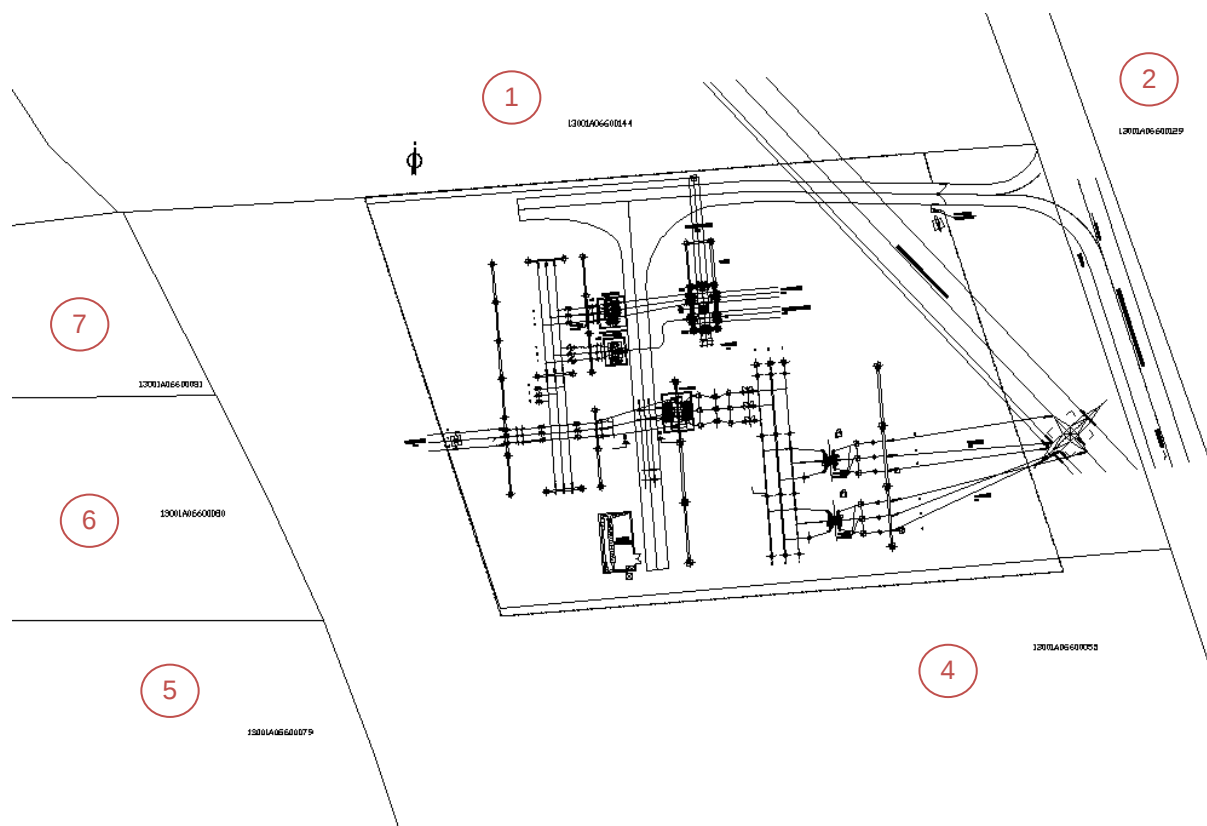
Distancias en planta general de la disposición de equipos de la subestación Abenójar
